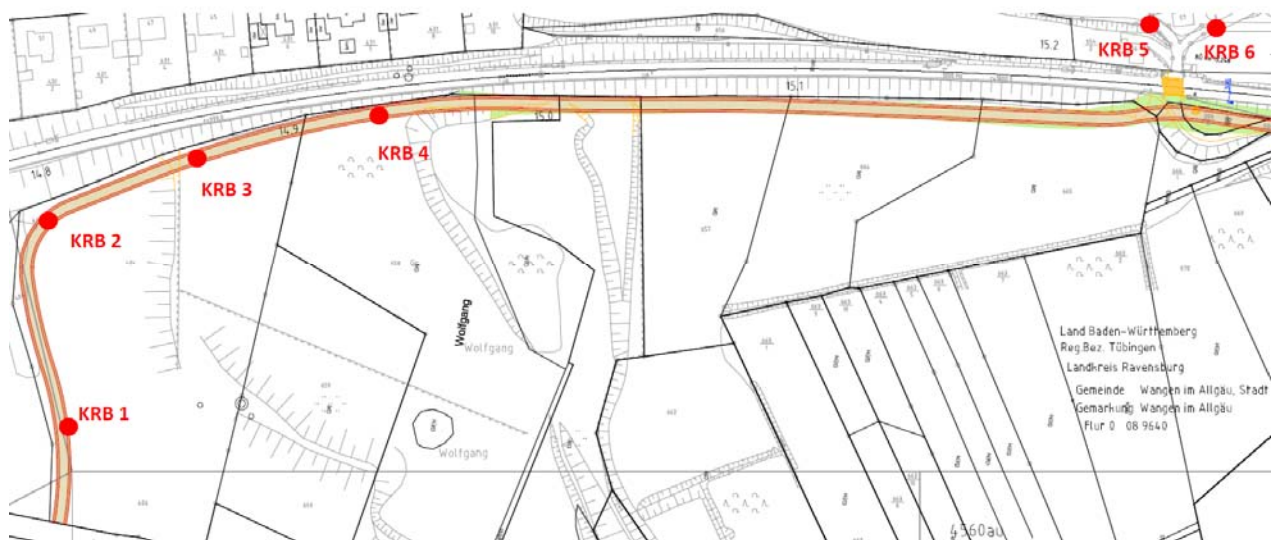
Lageplan des geplanten Ersatzweges mit Untersuchungspunkten
